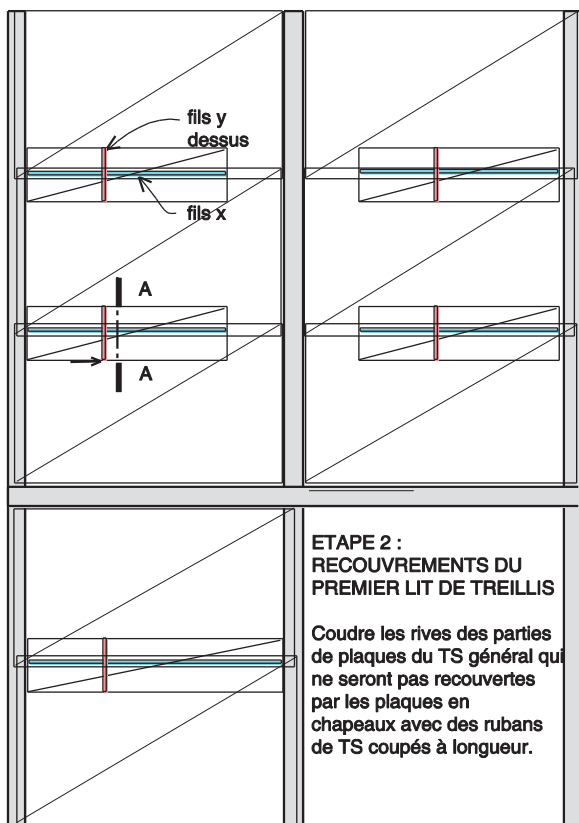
Mise en place du ferrailage dans la dalle – phase 2
